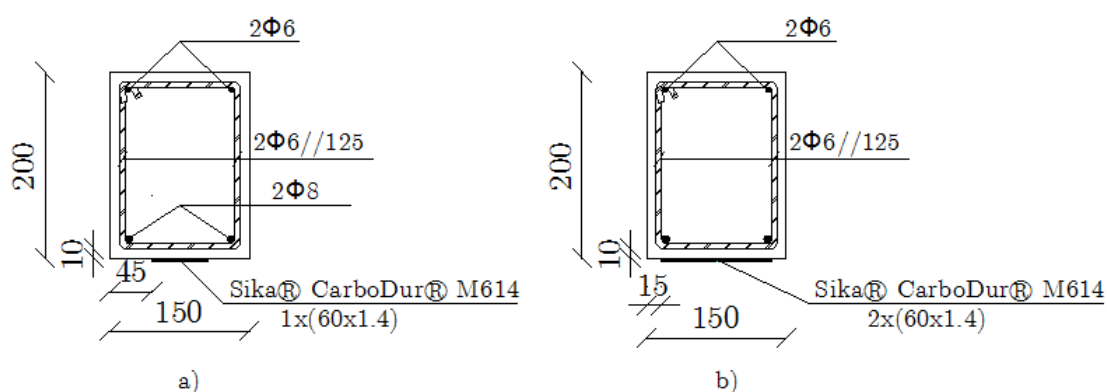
Secção transversal das vigas reforçadas: a) FRP1; b) FRP2
